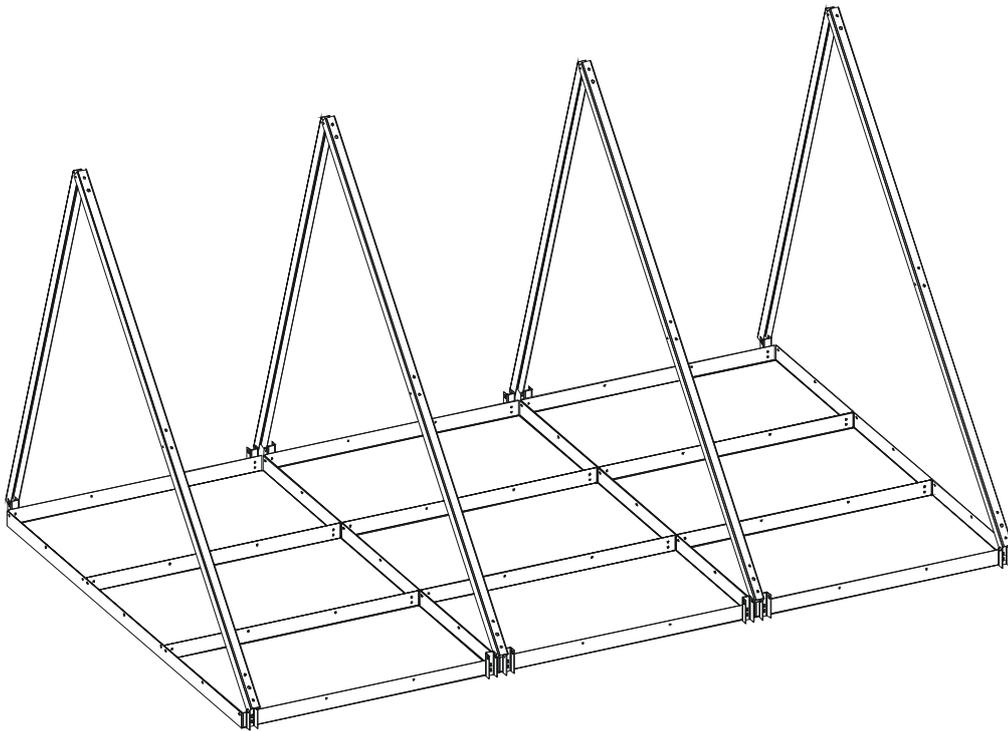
Exemples de supports toiture-terrasse avec planches de charge.
